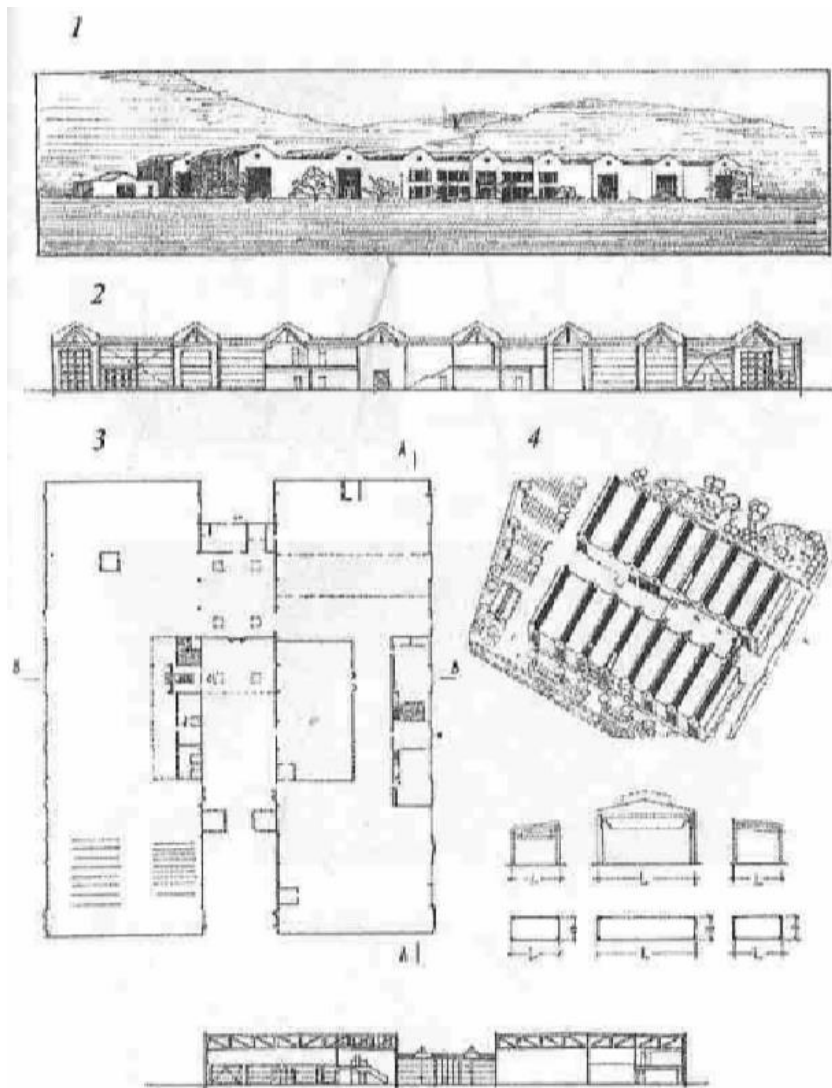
Одноповерхова промислова будівля. Приклад секційно-гребінчатого типу забудови прогонного типу будівлі König Metall in Gaggenau: 1- розріз А-А; 2 – план поверху; 3 – розріз В-В; 4 – приклад об'ємно-планувального елемента. []
